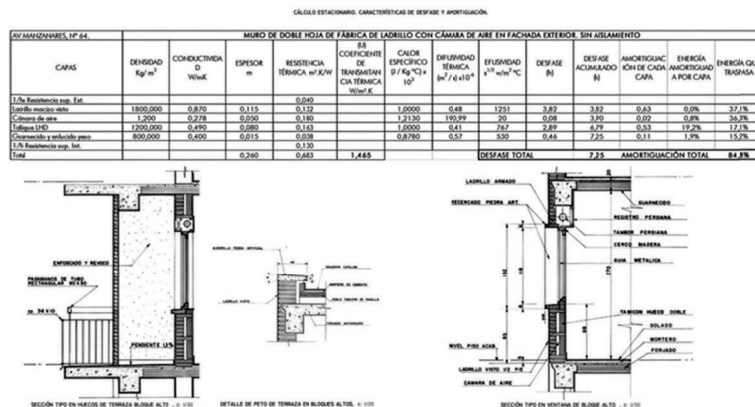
Ficha de caracterización del sistema constructivo de fachada. Edificio situado en la Avenida del Manzanares, nº 64.
